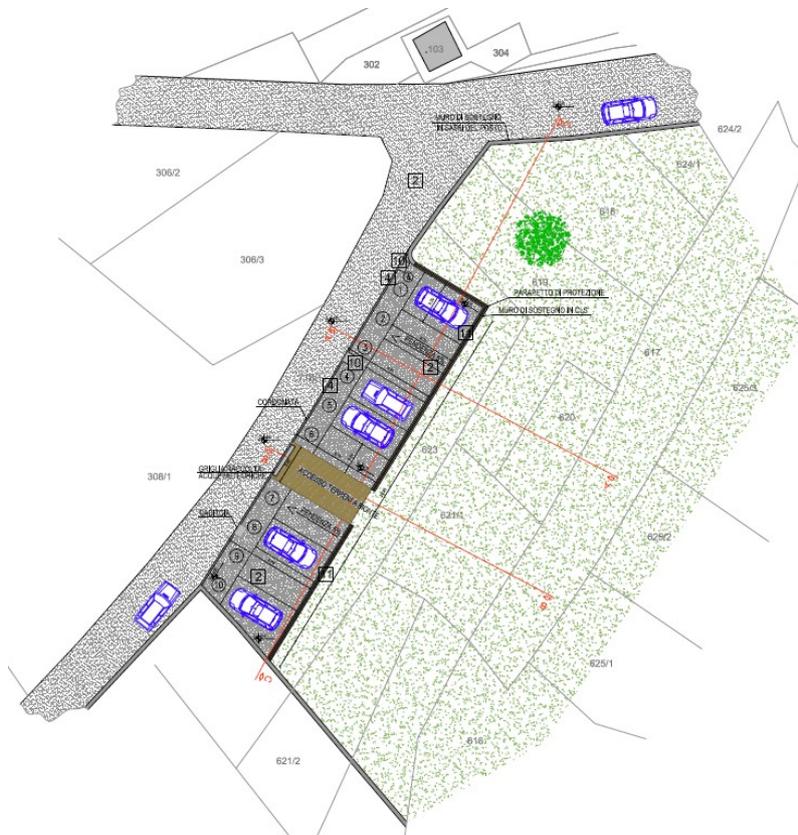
Estratto "Planimetria generale di progetto - intervento 6" scala a vista.
